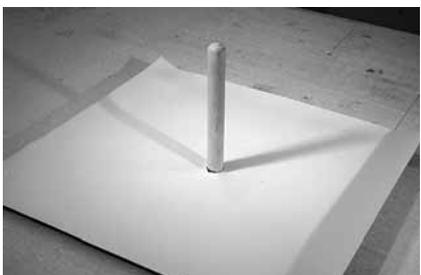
Для герметизации такого элемента в кровле (громоотводы, абели, стойки крепления и другие) вырезают из неармированной мембраны круг радиусом около 150 мм.
